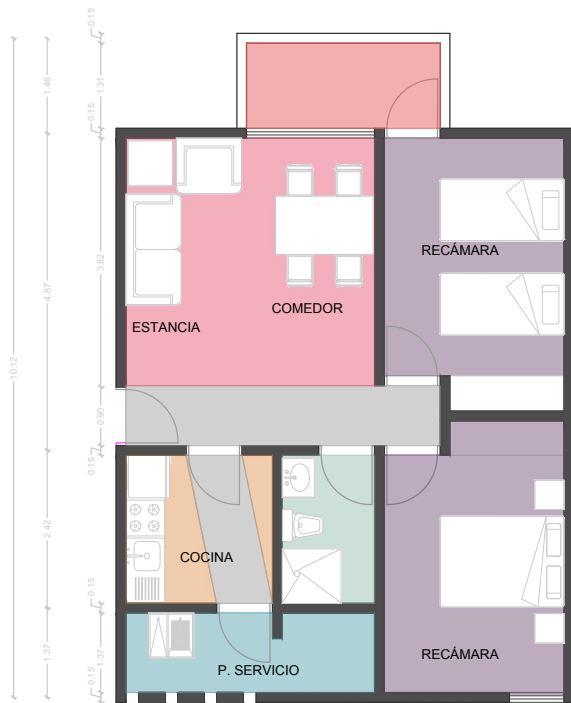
Planta arquitectónica original departamento tipo B-01 Fuente: Elaboración propia
